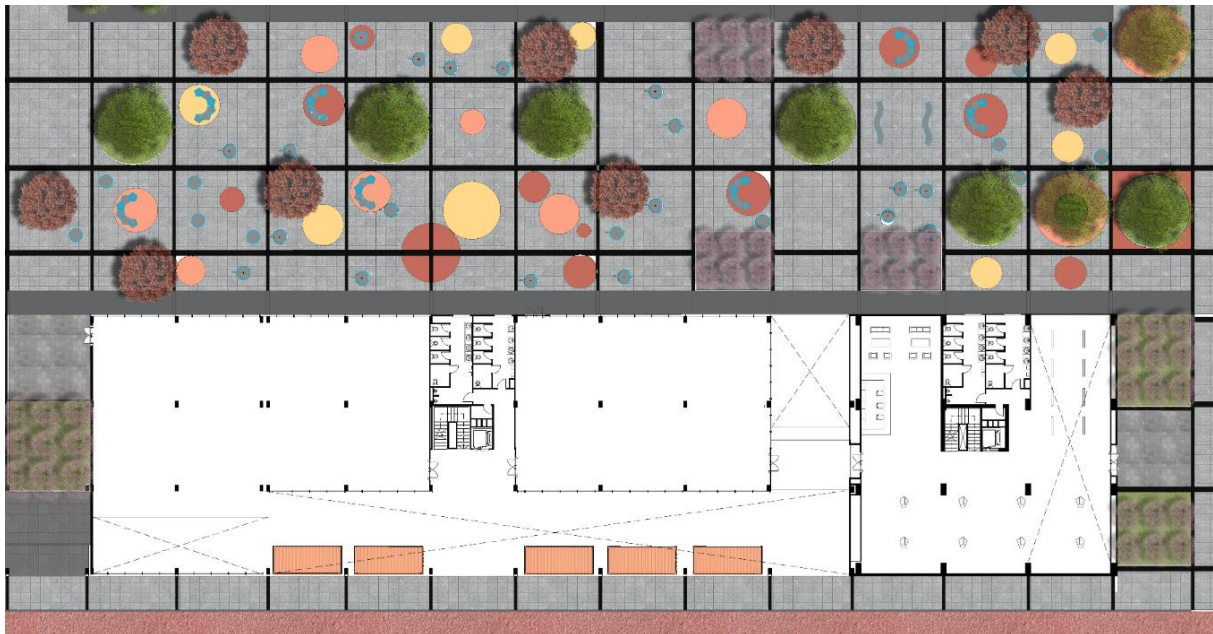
Planta baja Bloque Centro Cultural y Torre Multifuncional. Fuente: Elaboración Propia
